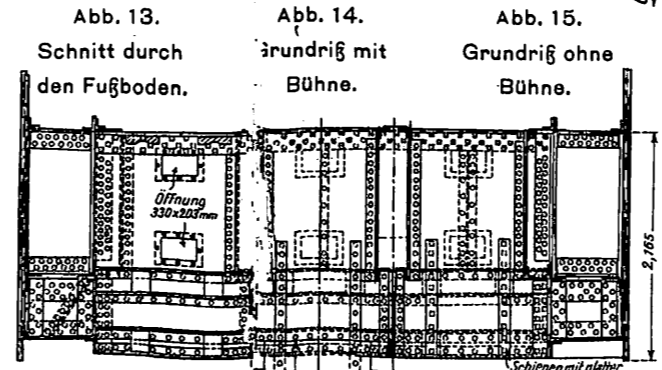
Schnitt durch den Fußboden. Abb. 14. Grundriß mit Bühne. Abb. 15. Grundriß ohne Bühne.
